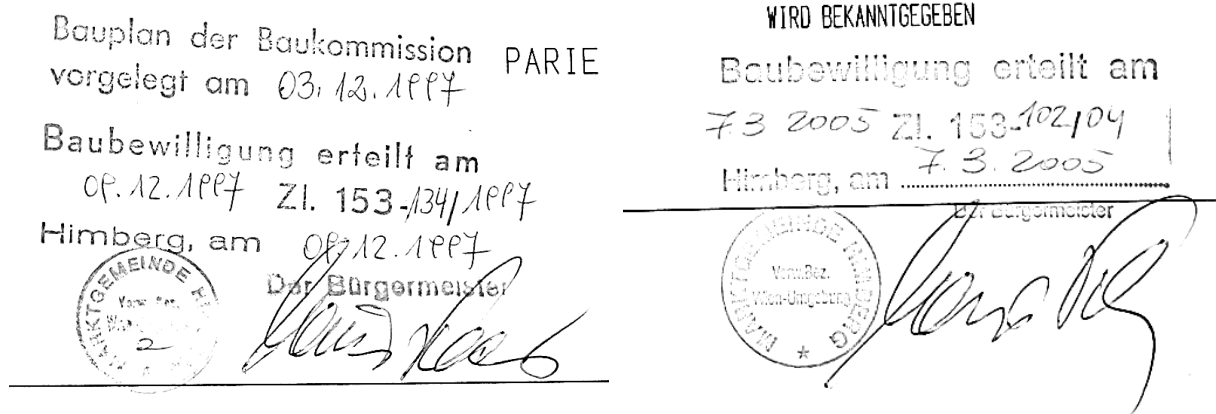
Genehmigungsvermerke auf Einreichplan Dachgeschoßausbau
